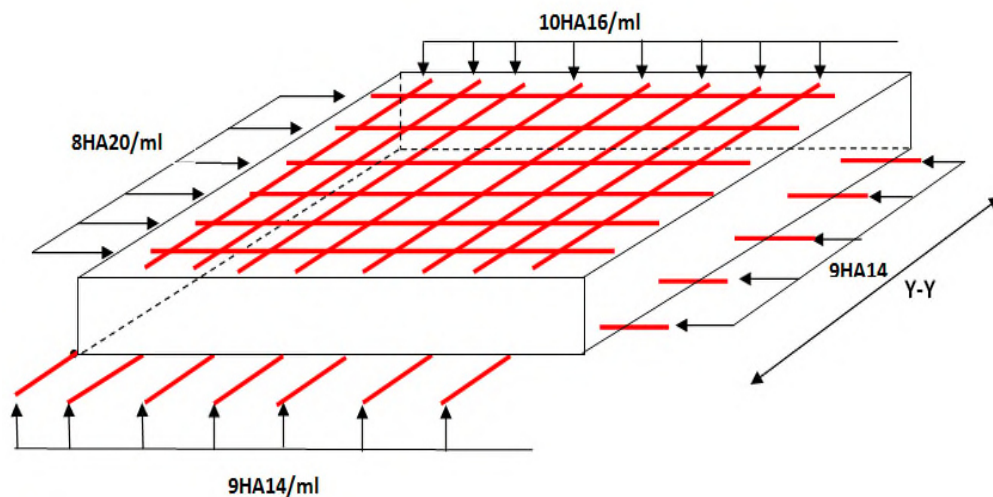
Schéma de ferrailage de la dalle du radier.
